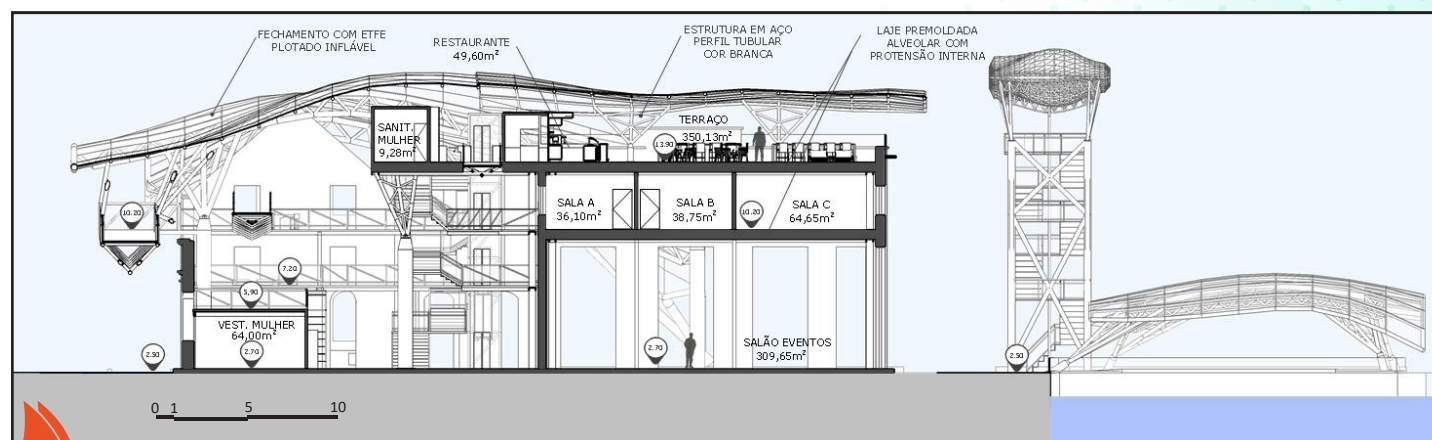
Corte EE. Planta técnica anexa em escala 1:200. Rafael Rodamilans, 2018
